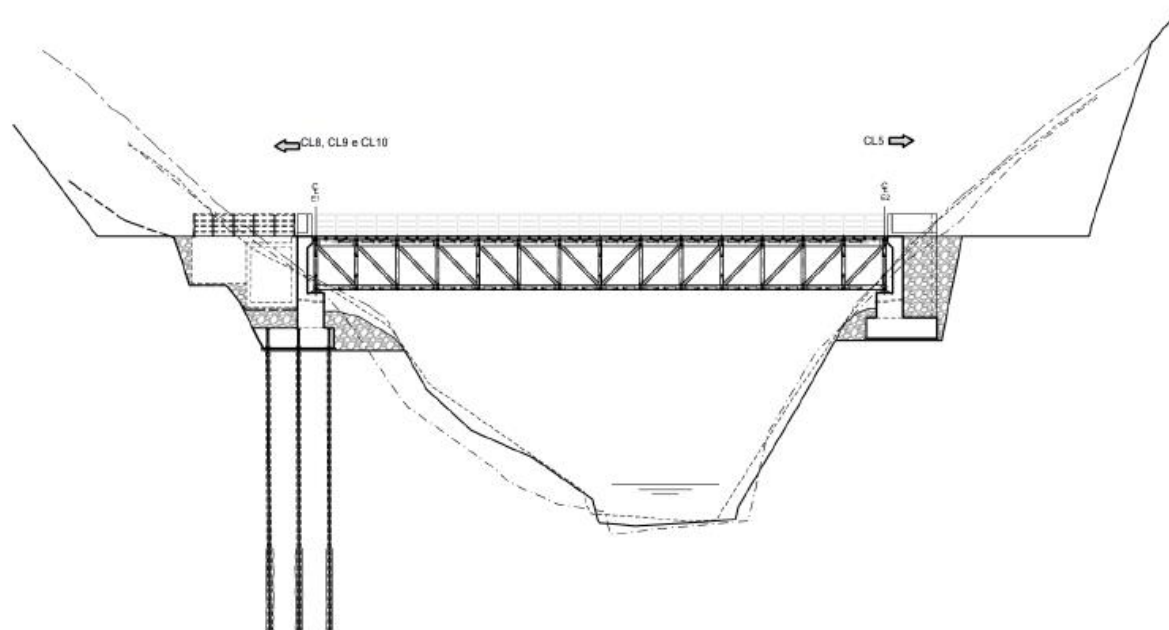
Fase IV: Execução da Ponte metálica e instalação de equipamentos
